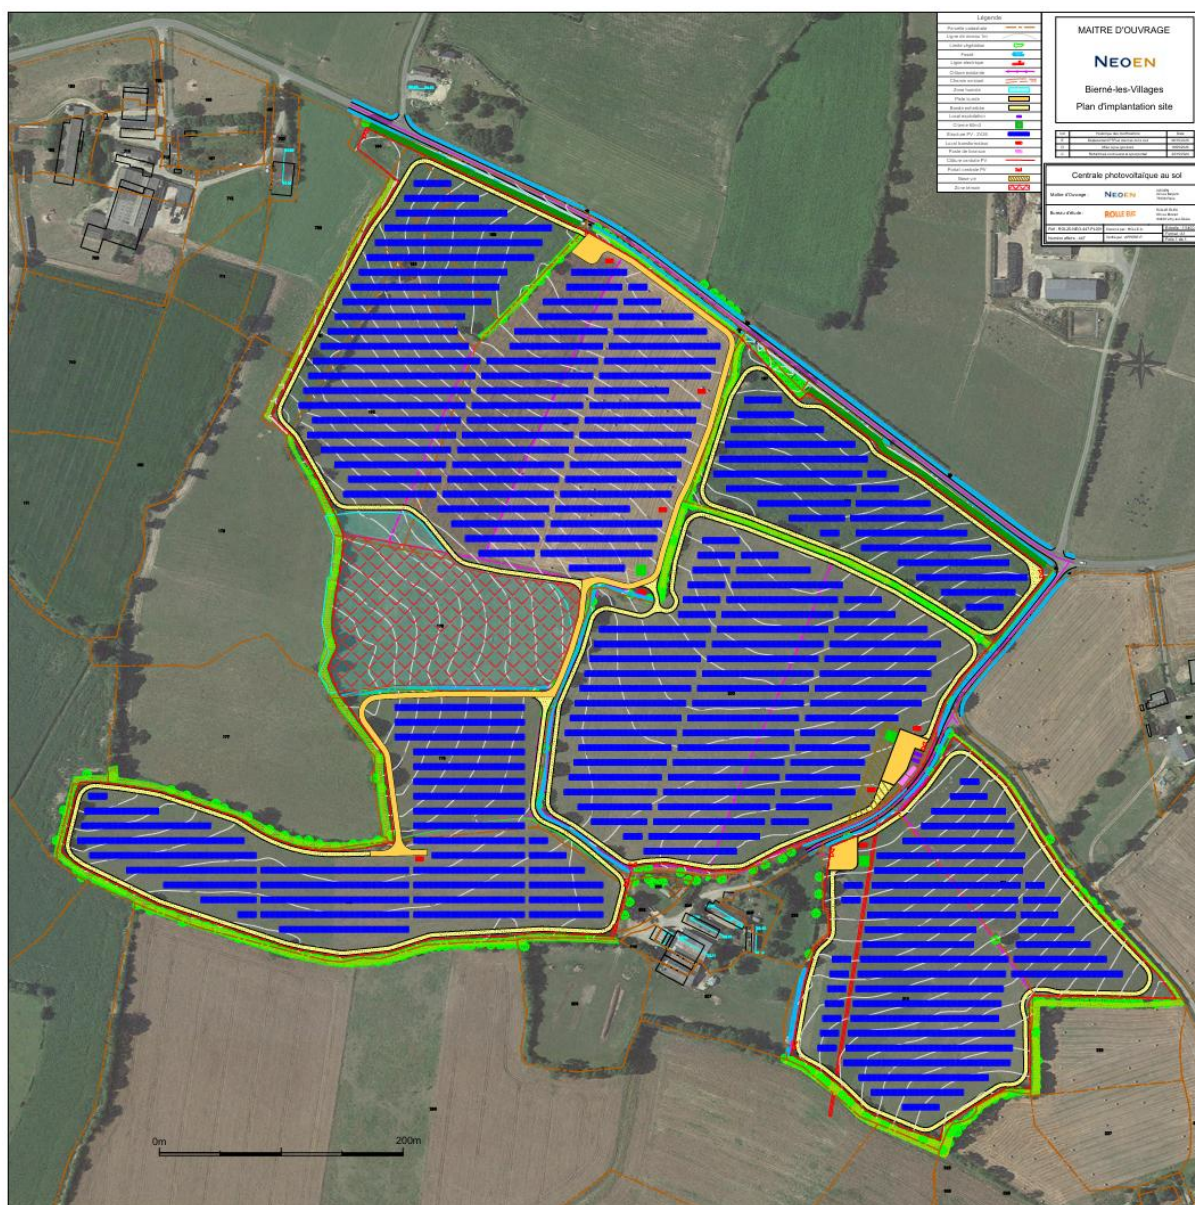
Plan de Masse projet agrivoltaïque de Bierné-les-Villages
